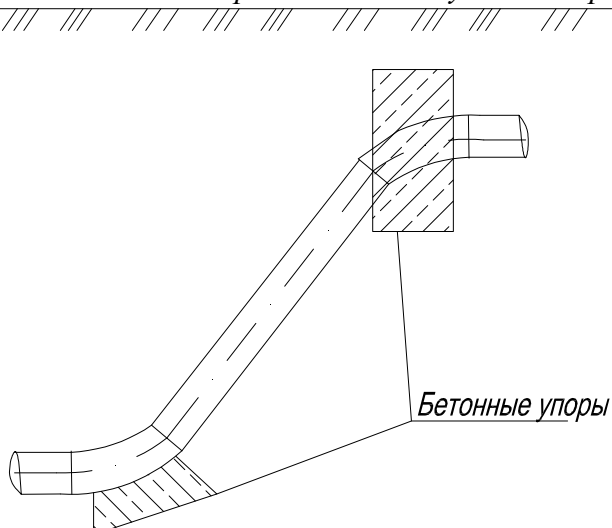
Типовая схема обустройства вертикального угла поворота опорными блоками.
